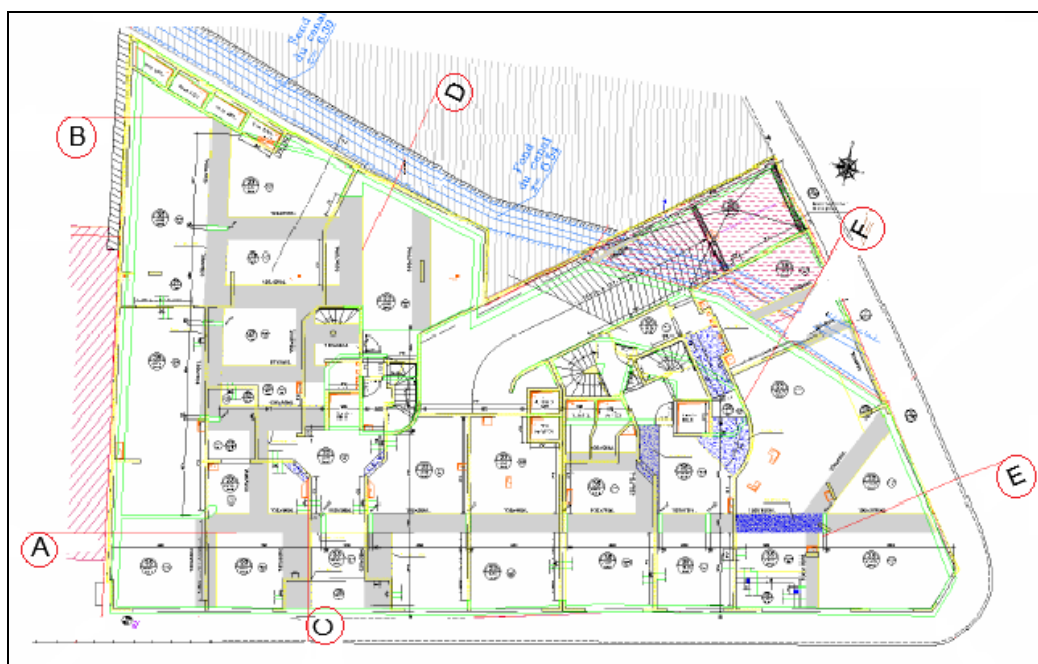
Planta da obra com indicação das seis secções de cálculo consideradas
